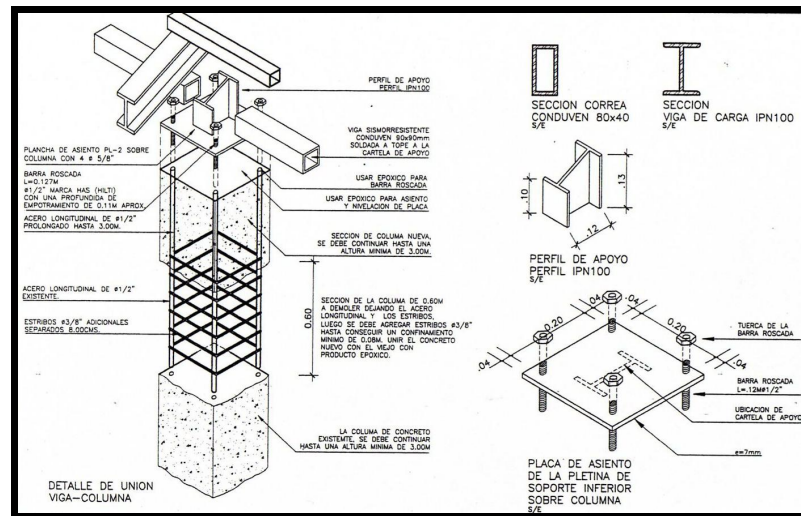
Detalle de prolongación de columna de concreto. Manual FEDE.
